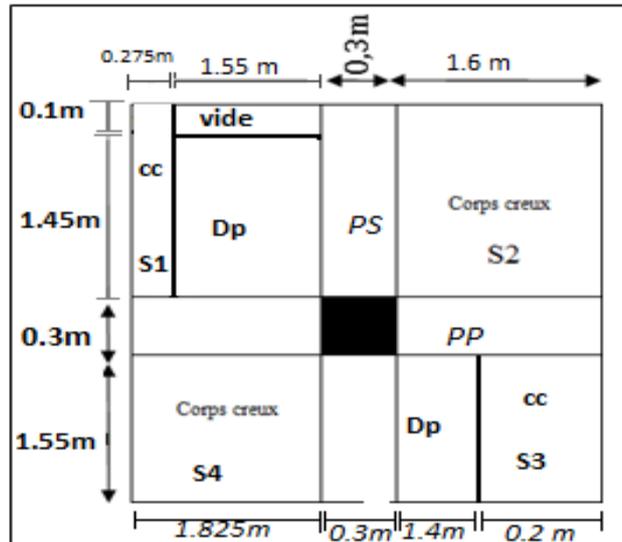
La surface afférente du poteau PB6. (Terrasse inaccessible + Etage courant.
